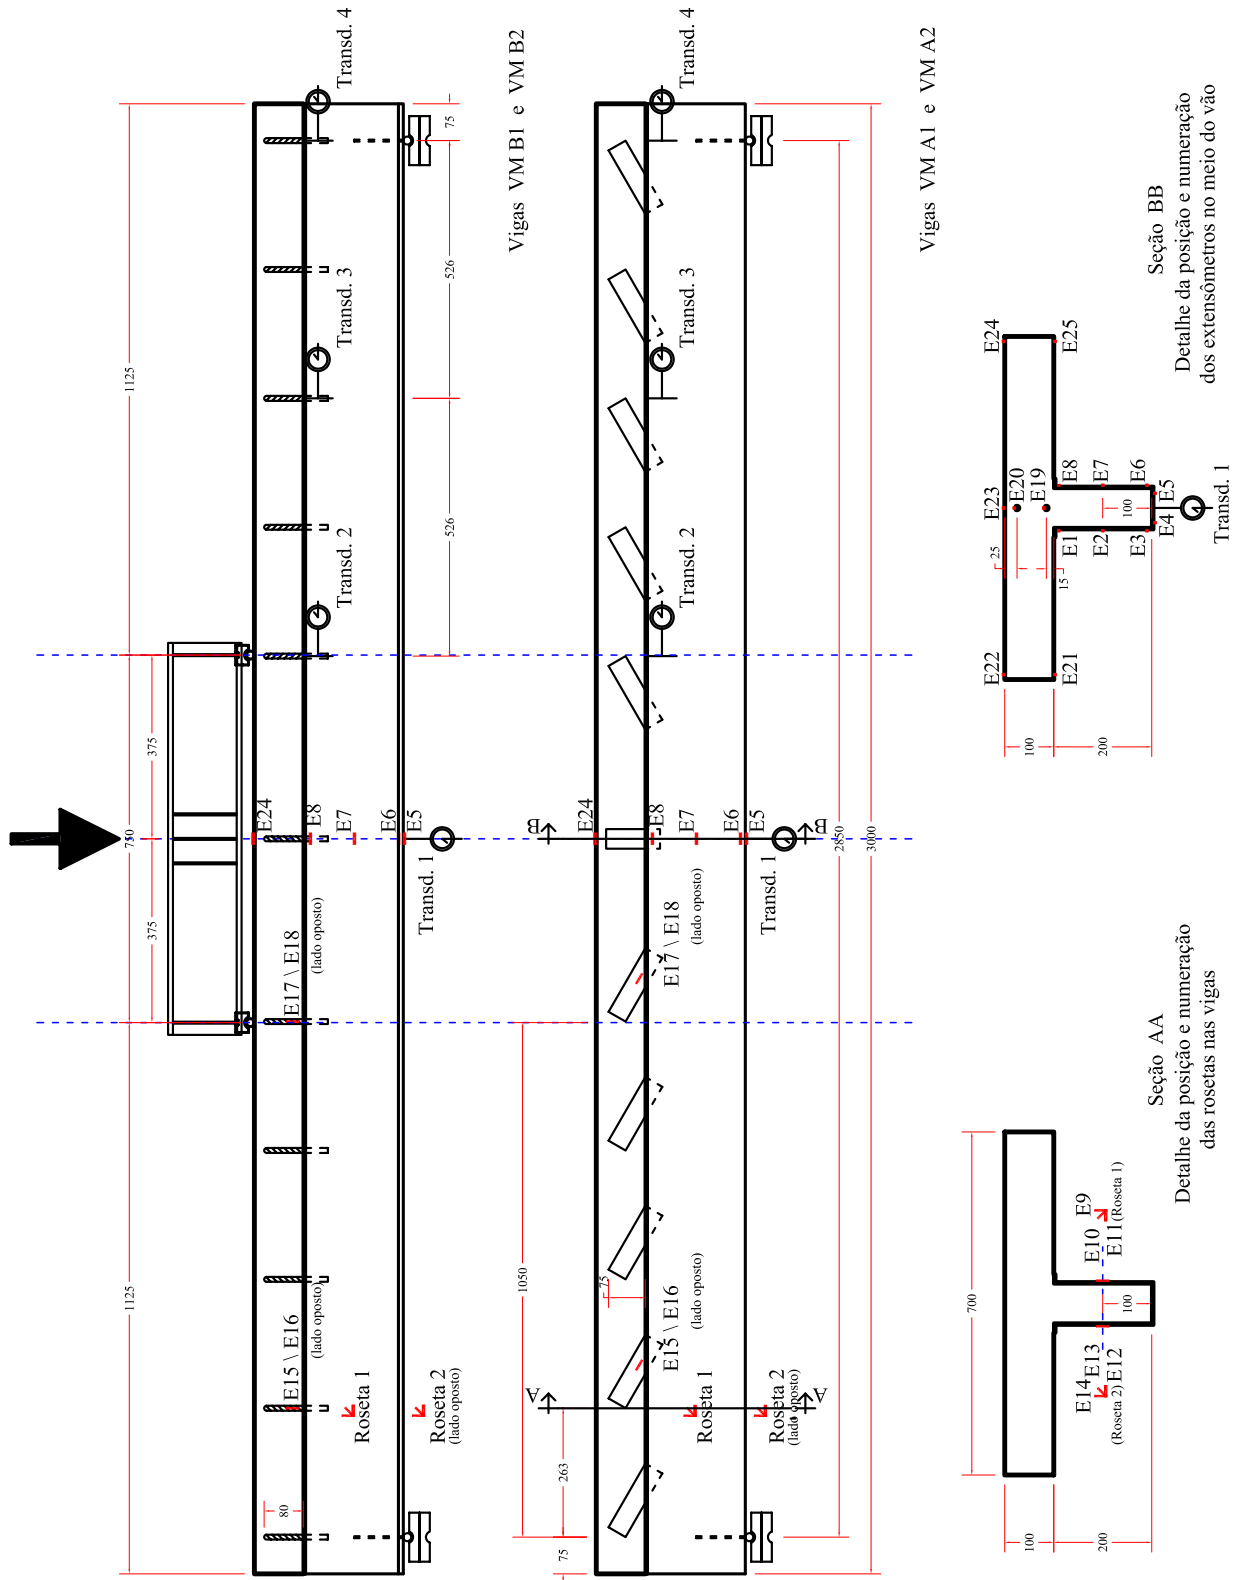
Detalhamento das Vigas Mistas - Instrumentação e Carregamento.
